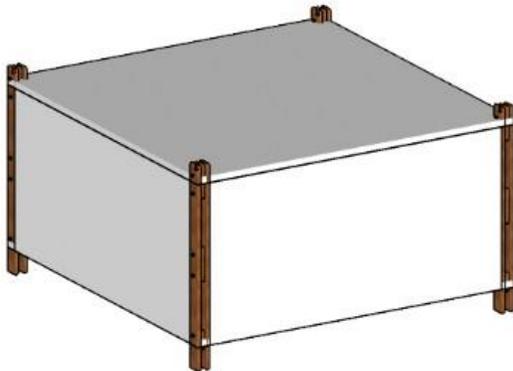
Esquema columna (Fuente: Alejandra Durán)
